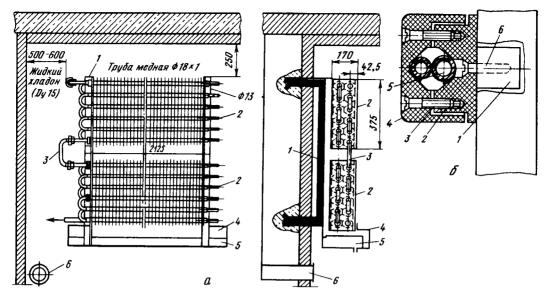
Схема монтажа хладоновых батарей и трубопроводов:
